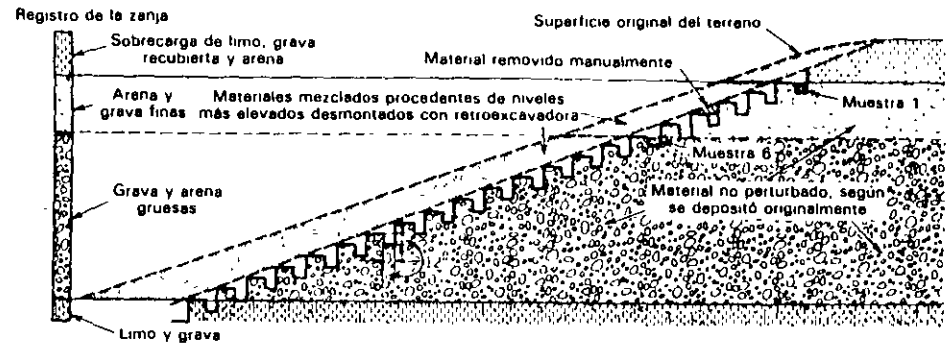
Perfil de una zanja. (Fuente: U.S. Bureau of Reclamation.)
